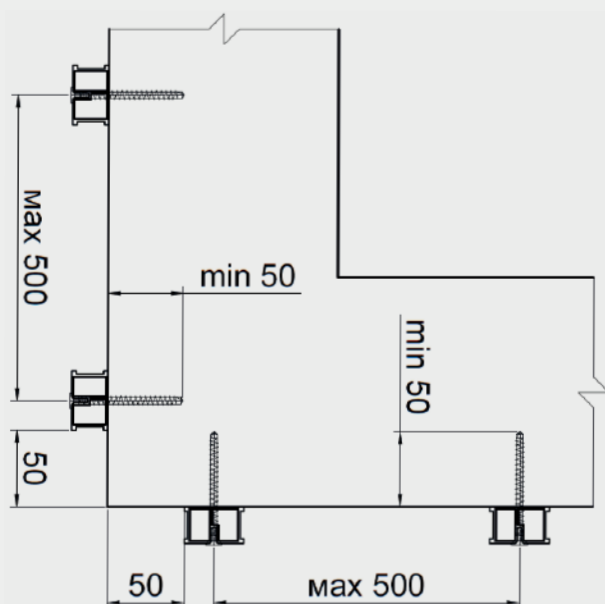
Instalación de un perfil portante para la fijación de la fachada en posición horizontal
